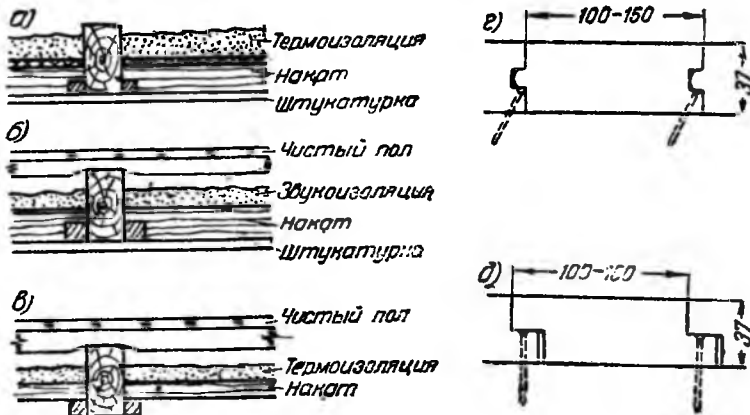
Принципиальная схема верхнего, междуэтажного и нижнего перекрытий
